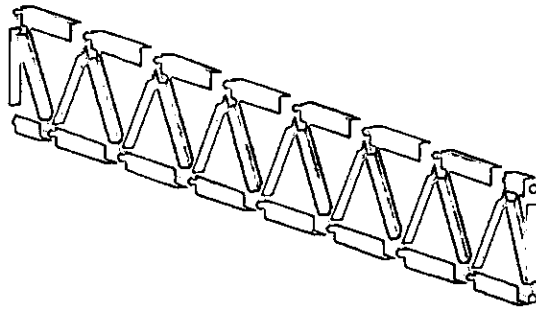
Vista en 3D de la Viga en Celosía.
